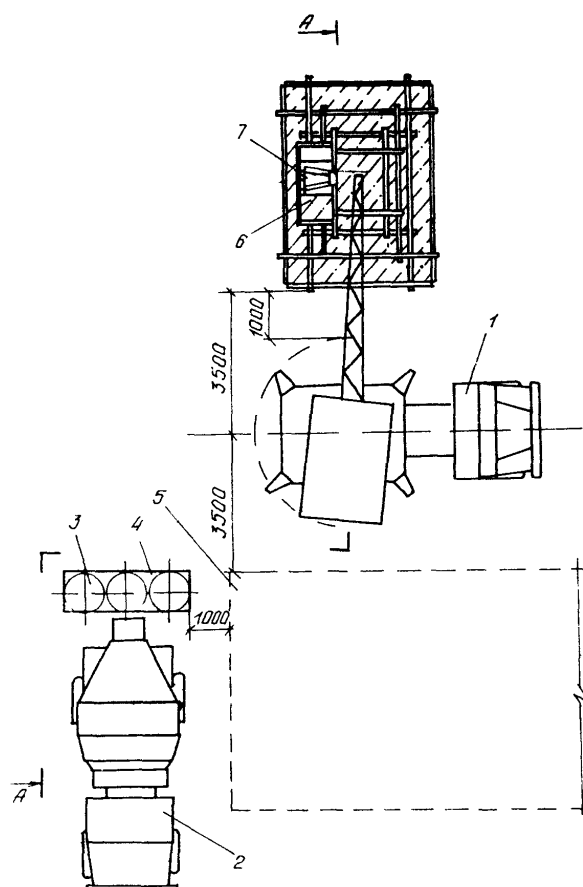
Схема организации работ при подаче бетонной смеси краном в бункерах
